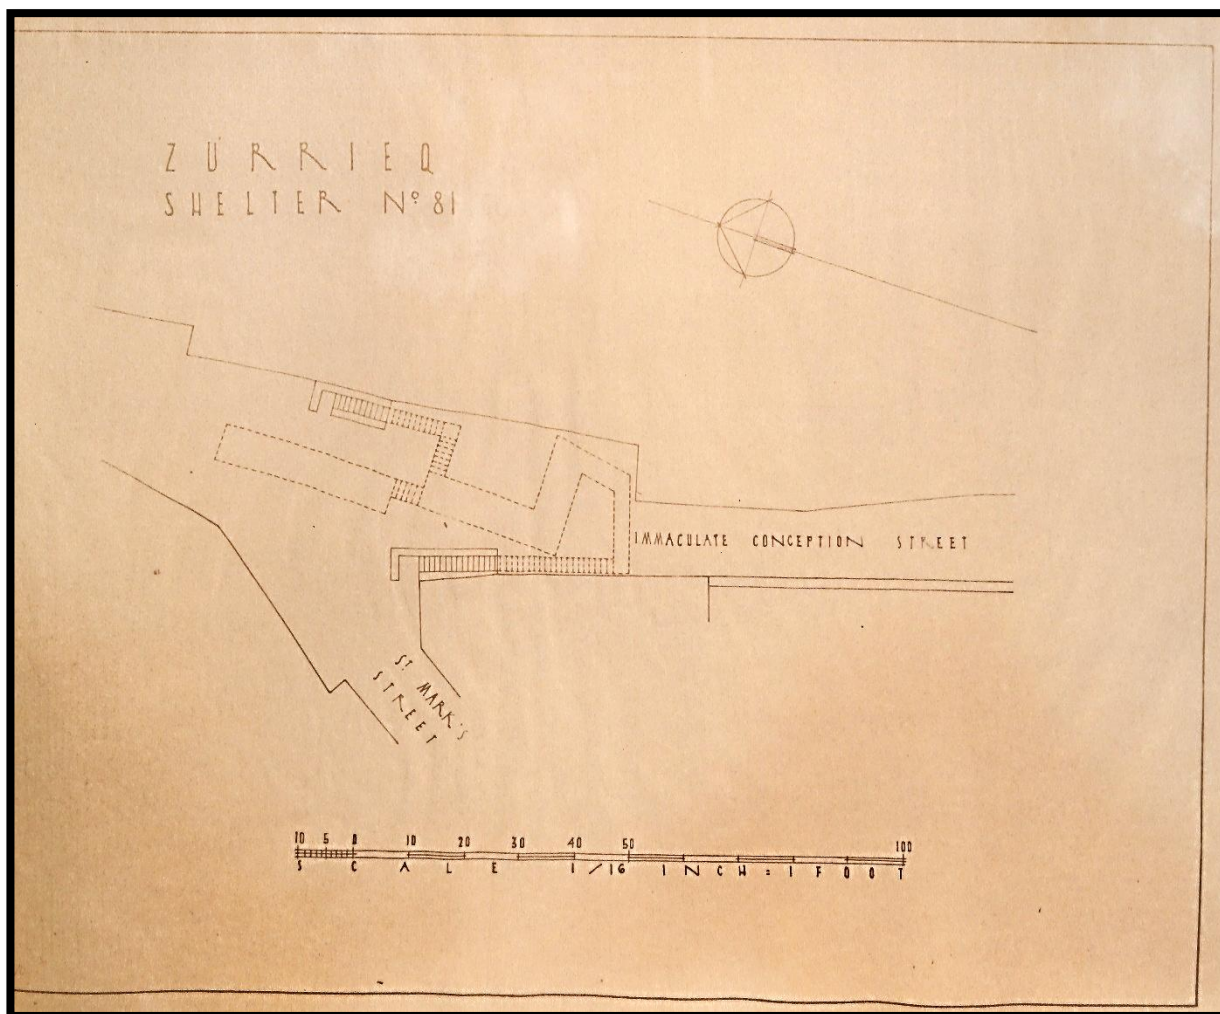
Planta do Abrigo nº81 "St. Mark's Street - Immaculate Conception Street."
